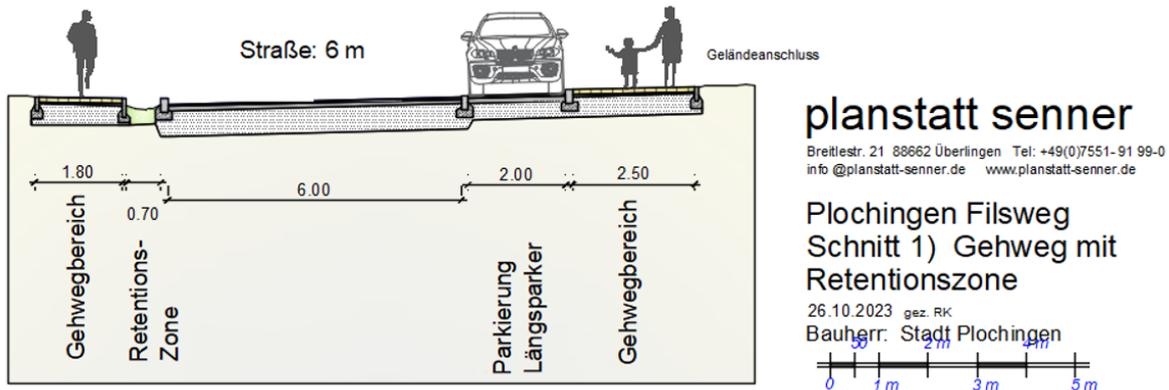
Lageplan Straßenquerschnitt 1&2 Planstatt Senner GmbH
